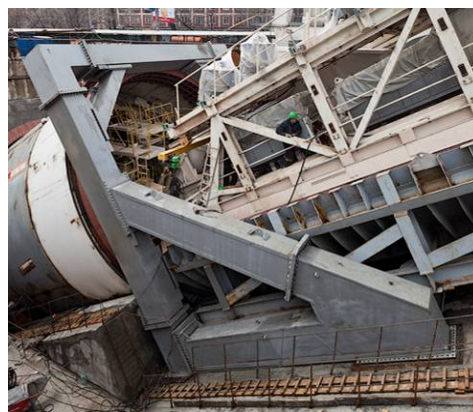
Рамная конструкция многоразового стартового упора на железобетонном фундаменте
